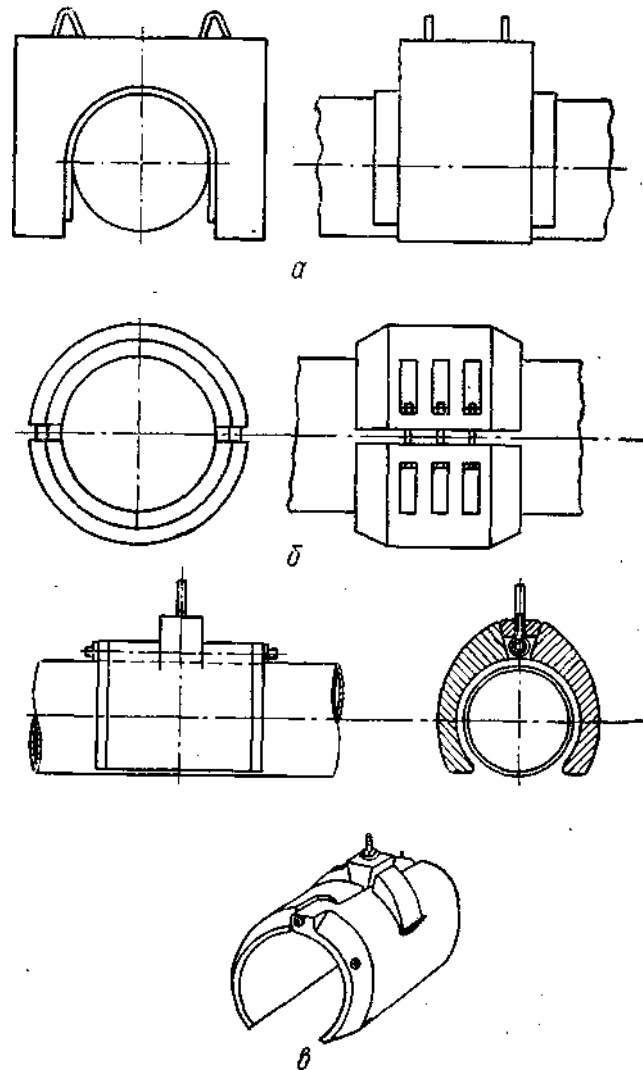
Типы грузов для балластировки трубопроводов: а — седловидный железобетонный, б — кольцевой чугунный, в — шарнирный.
